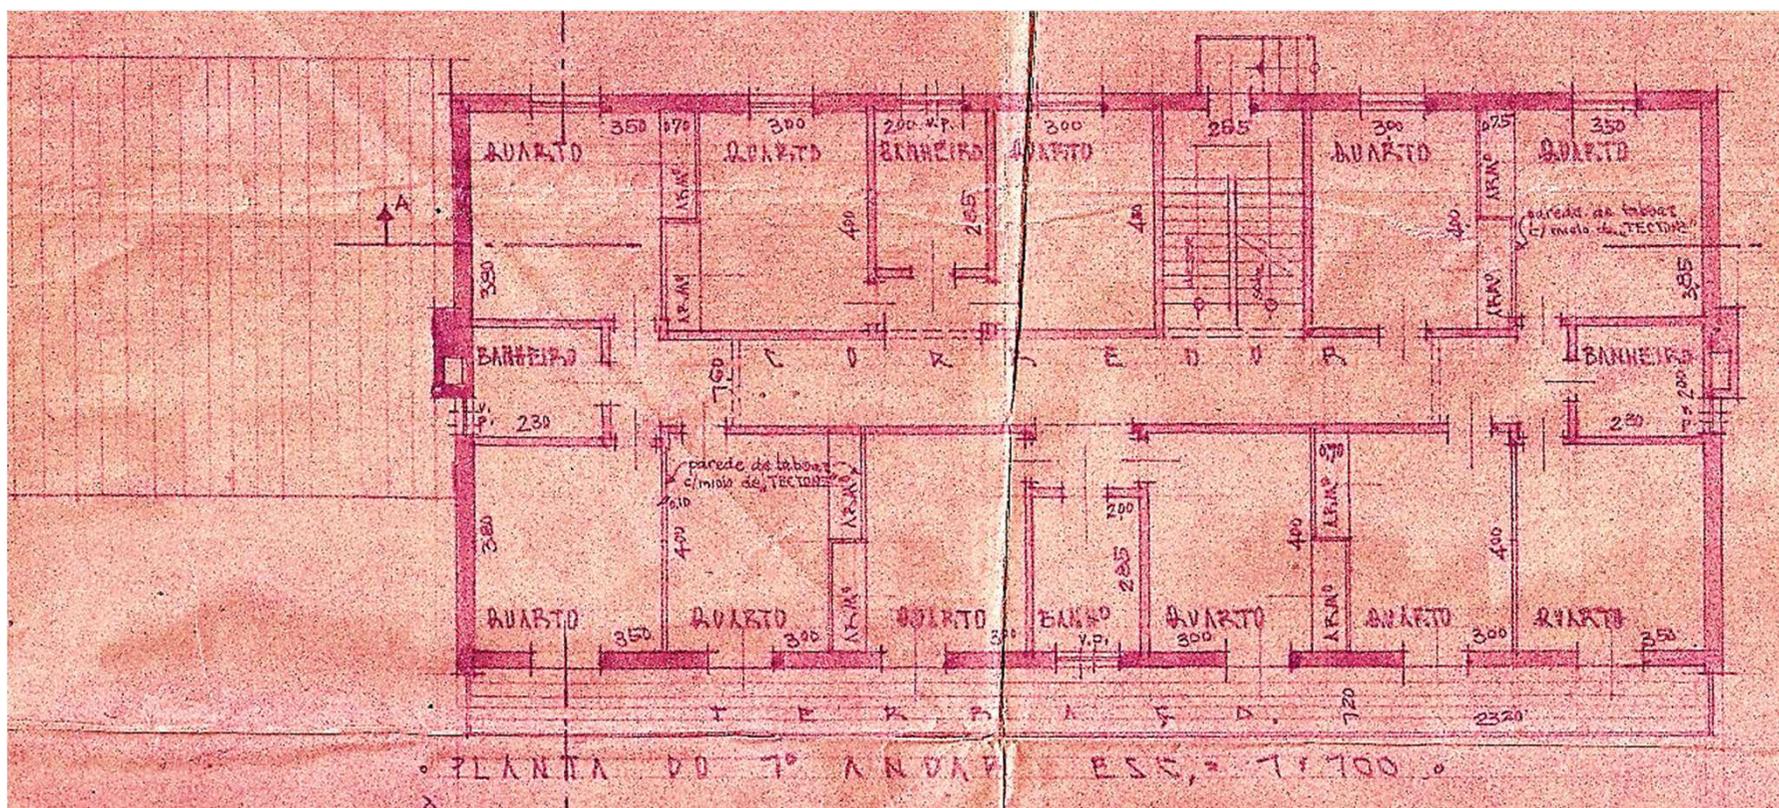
Planta baixa do pavimento-tipo dos apartamentos.
